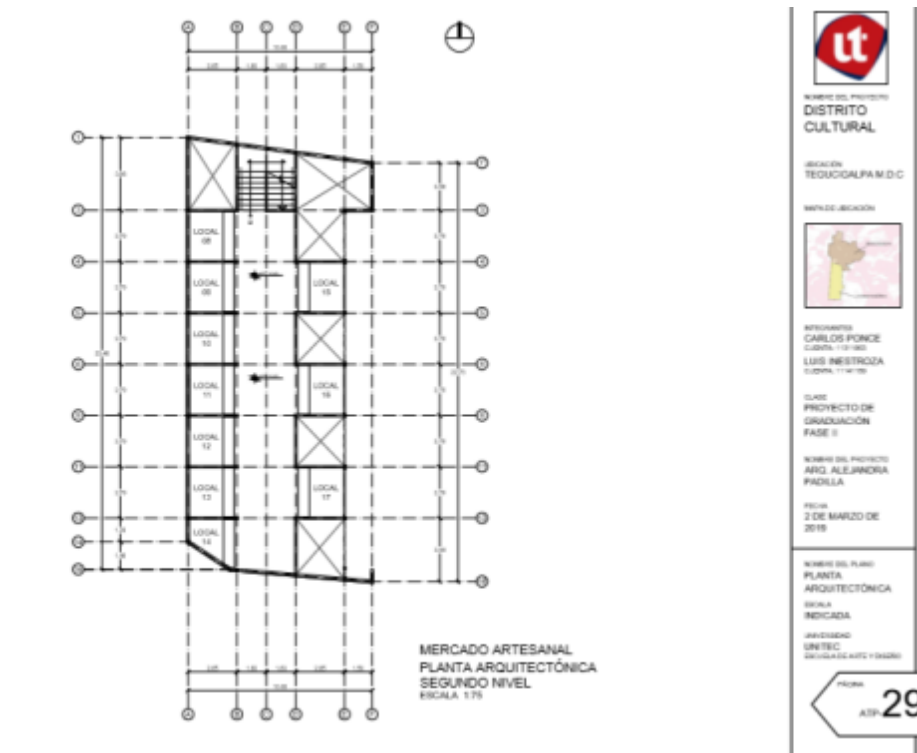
Planta Arquitectónica Mercado Artesanal Segundo Nivel
